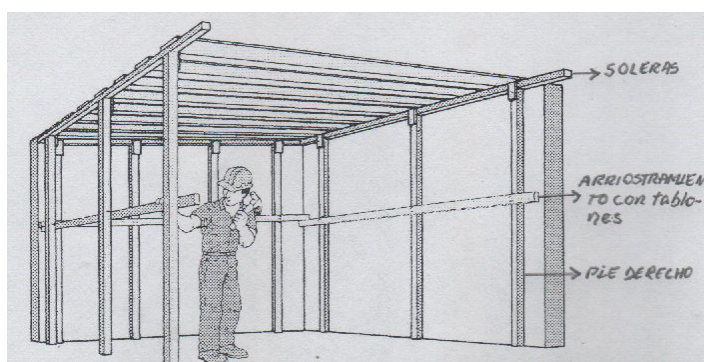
Encofrado de losa aligerada (SENCICO 2000)
